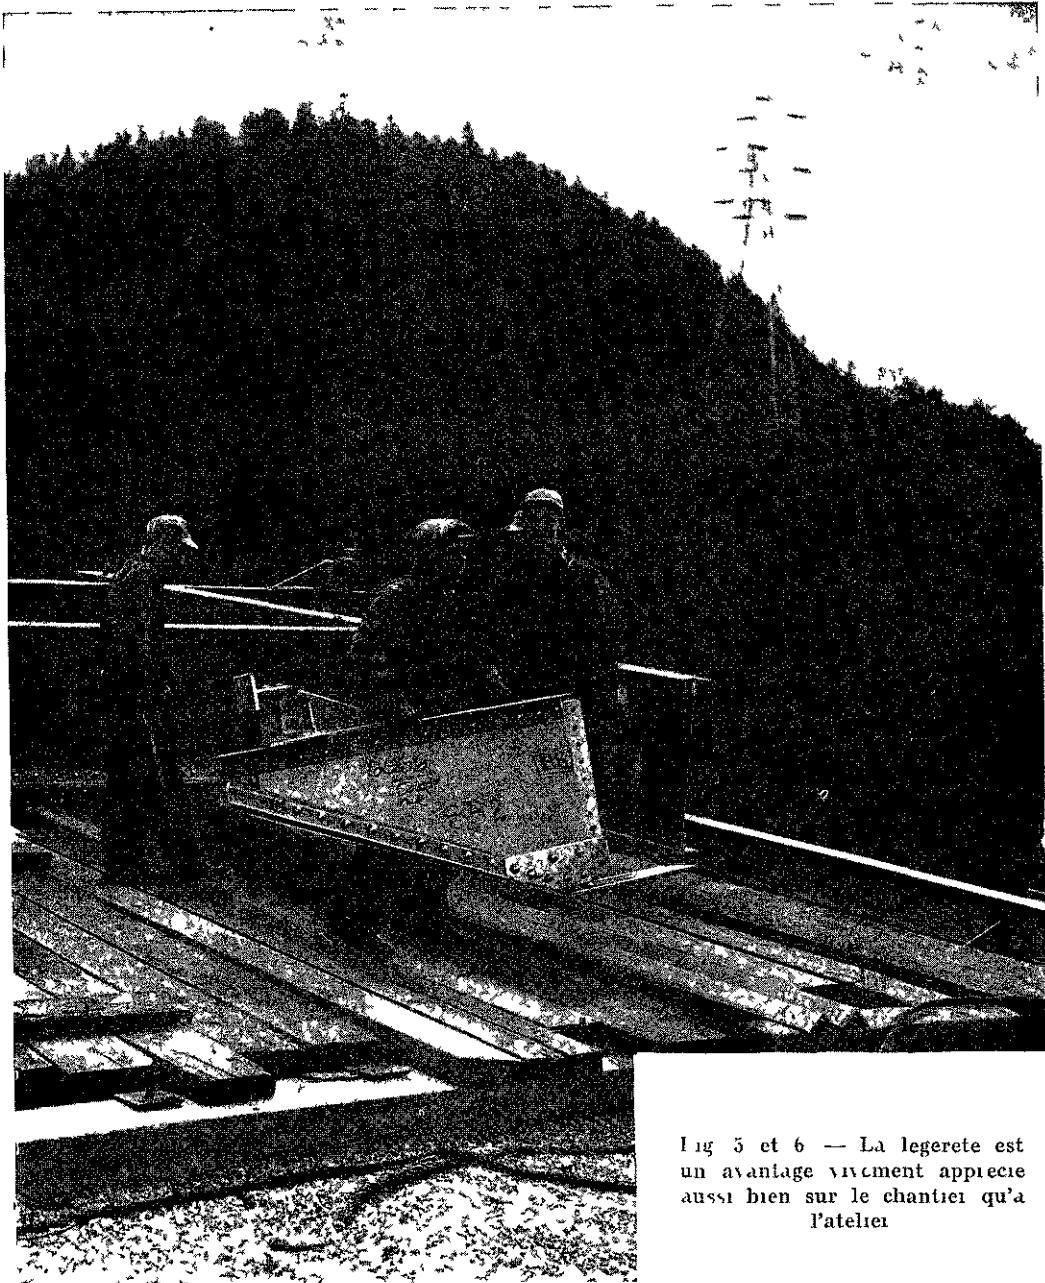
et 6 — La legerete est un avantage vivement apprecie aussi bien sur le chantier qu'a l'atelier
